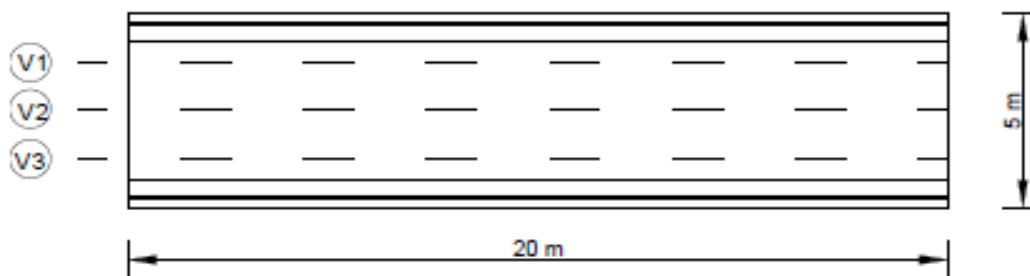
Vista en planta del tablero. Elaborado por: El autor
